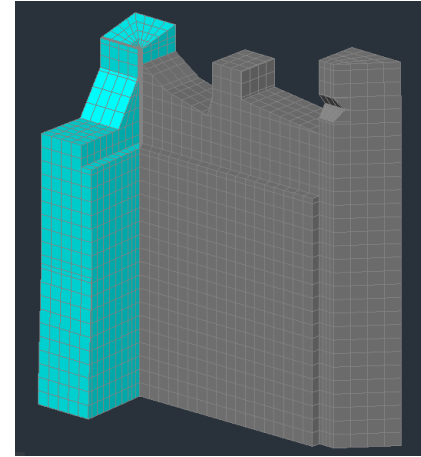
Mallado del muro de fachada de la torre 4 con orientación Noreste.
